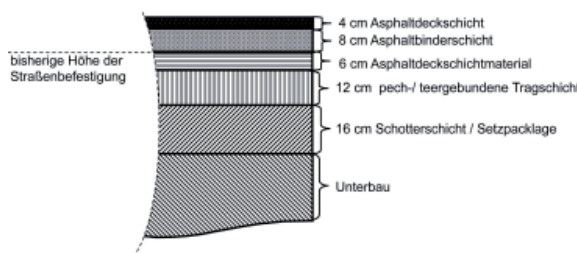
Schnittbild einer Straße nach Überbauen mit Asphalt
